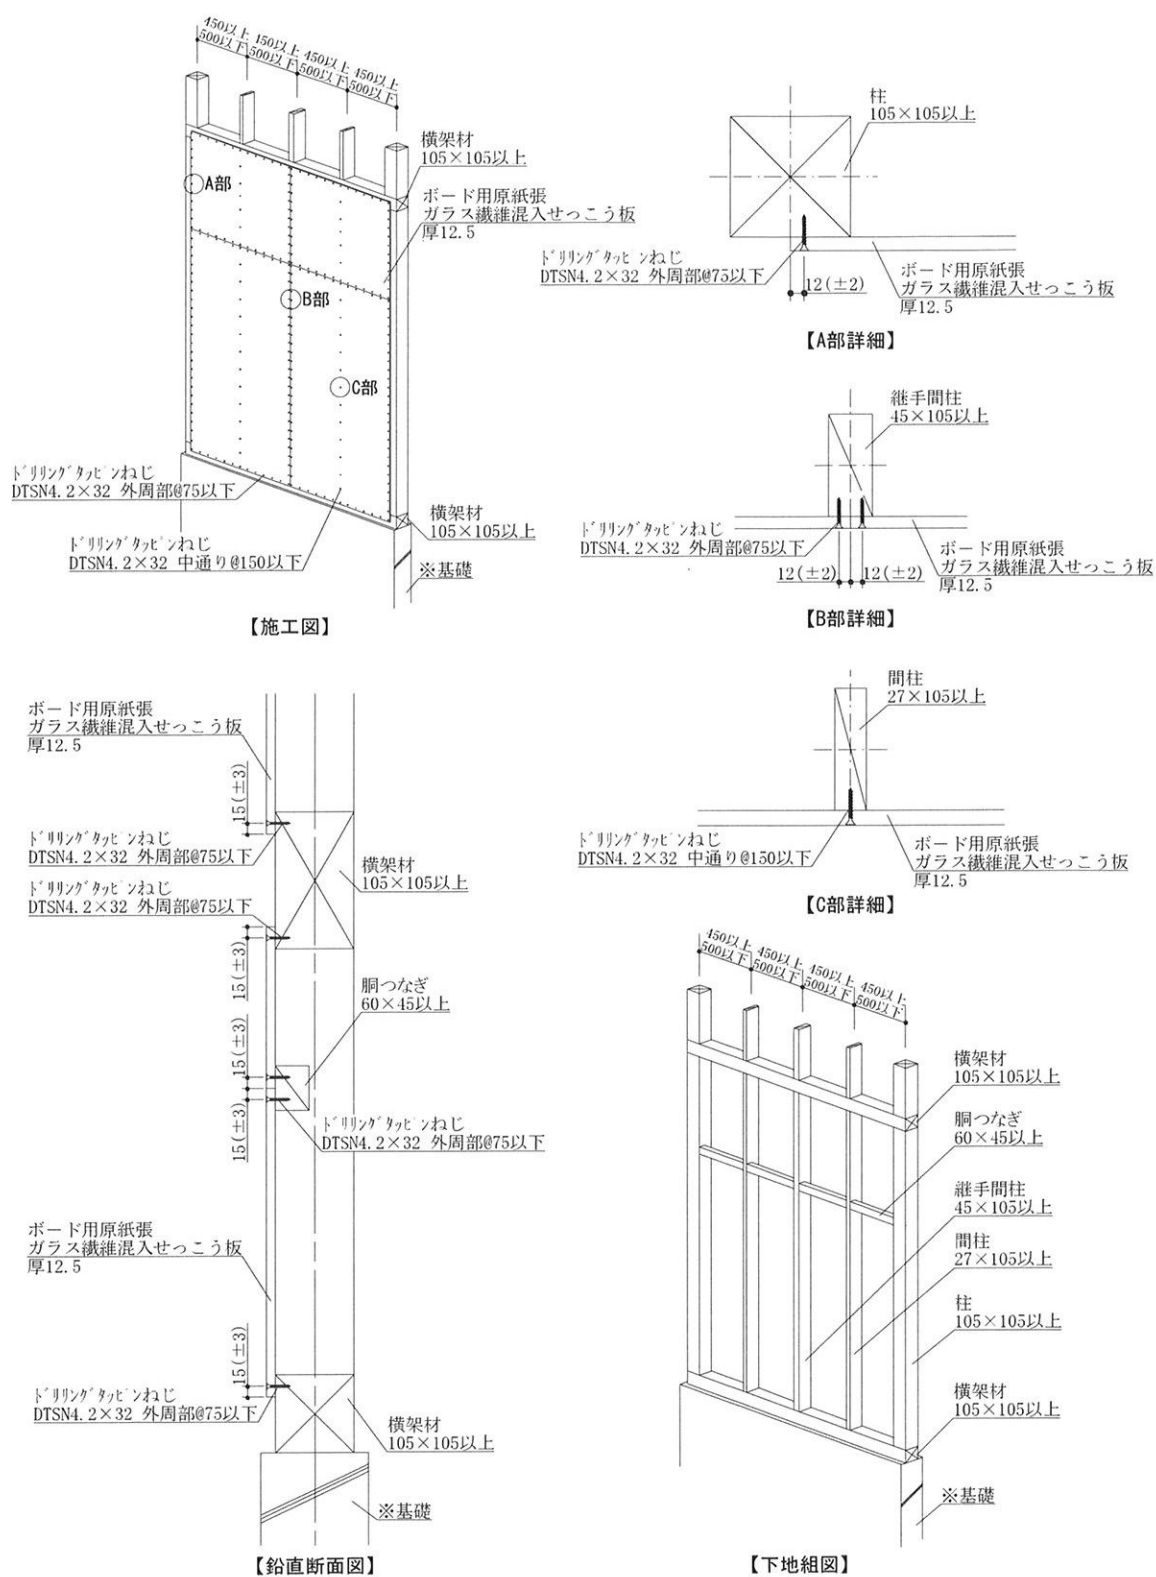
施工詳細図：縦継ぎ張りの場合（寸法単位：mm）
